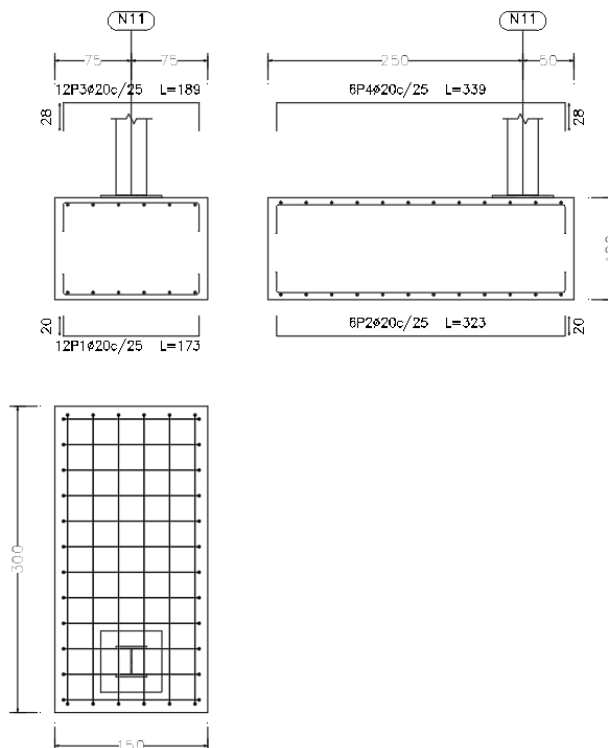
Zapata de cimentación de pilares laterales de pórticos interiores.
